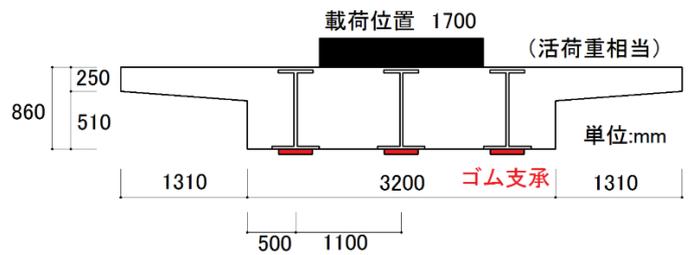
H 型埋め込み桁の断面図 (スパン 20m)
